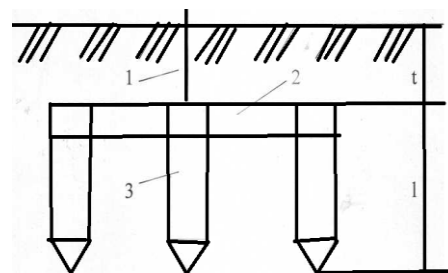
Заземлитель из трех труб, соединенных полосовой сталью: 1 – токоотвод из полосовой стали; 2 – заземлитель из полосовой стали; 3 – трубы стальные
